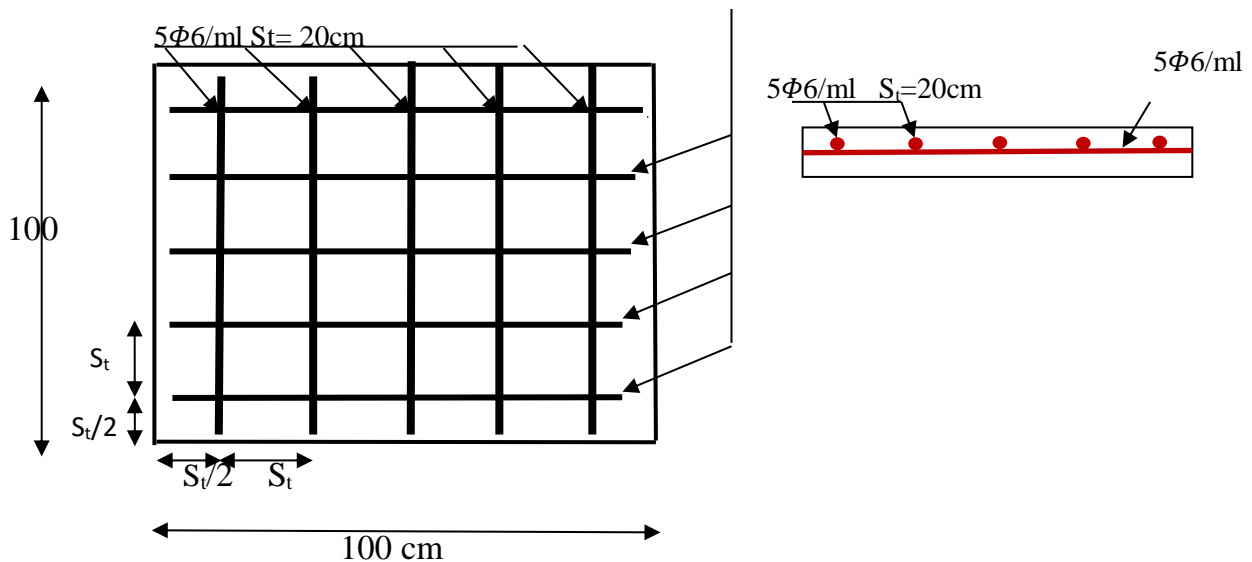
Disposition constructive des armatures de la dalle de compression
